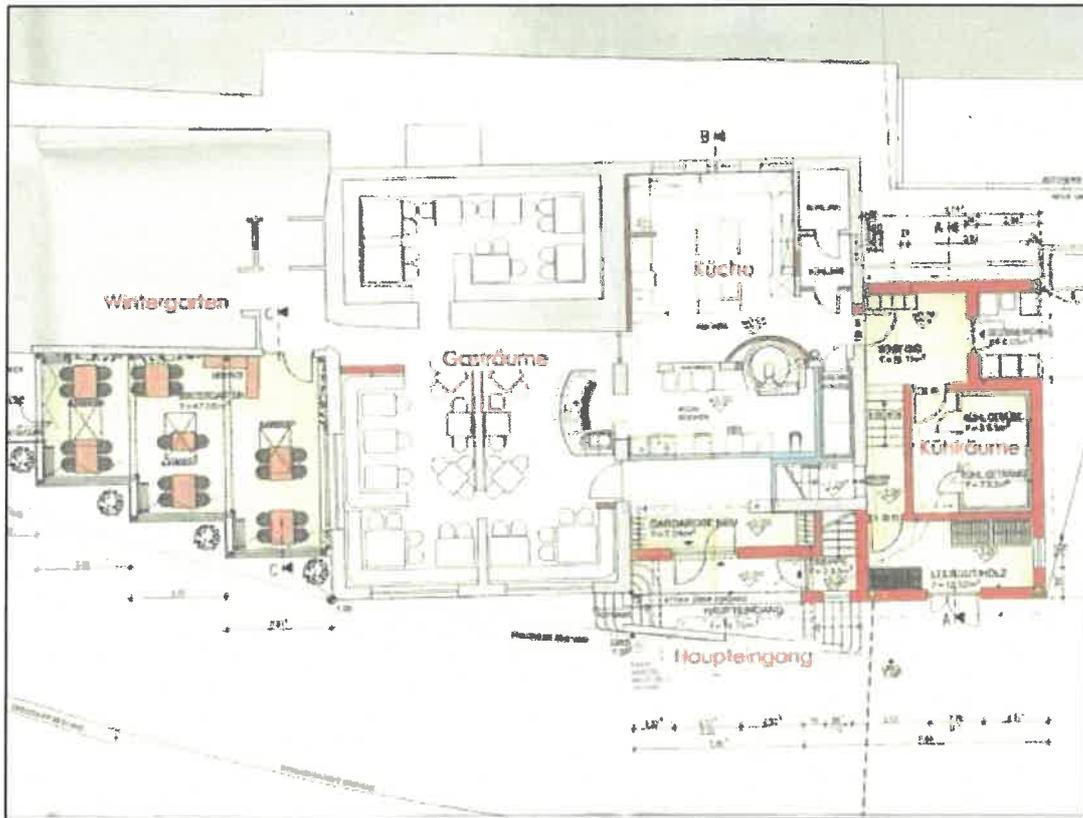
Grundriss Restaurant nach Durchführung der Umbaumaßnahmen /52/
